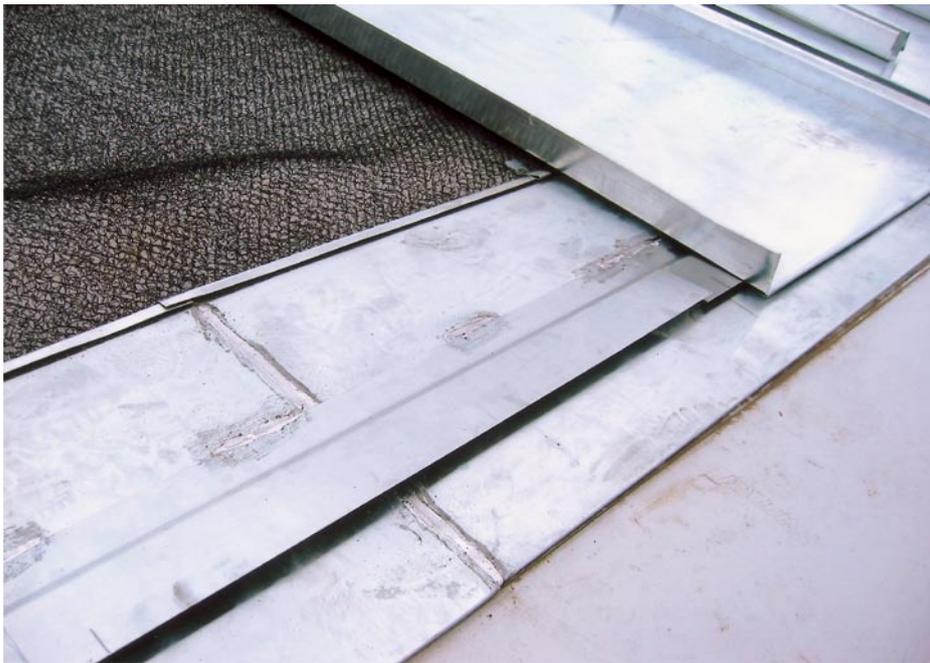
Anschlussdetail mit Klick-Leistendeckung und einem breiten, indirekt befestigten Traufstreifen mit Zusatzfalz. Darunter eine lose verlegte, strukturierte Trennlage.
